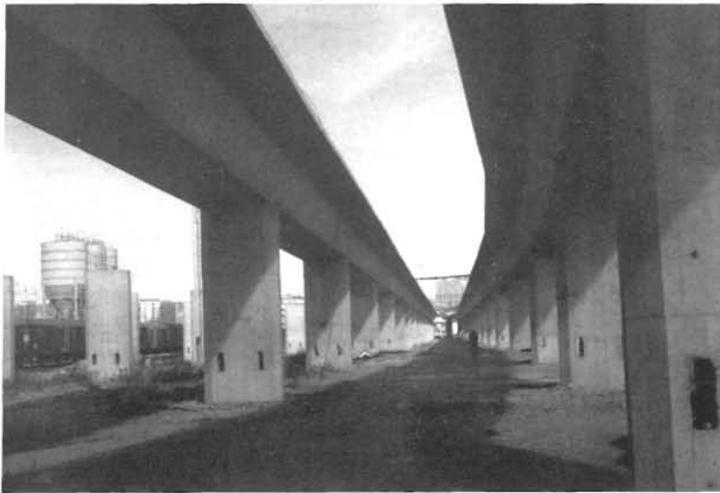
Construcción del andén. Al fondo puede verse el encofrado móvil para su construcción.
